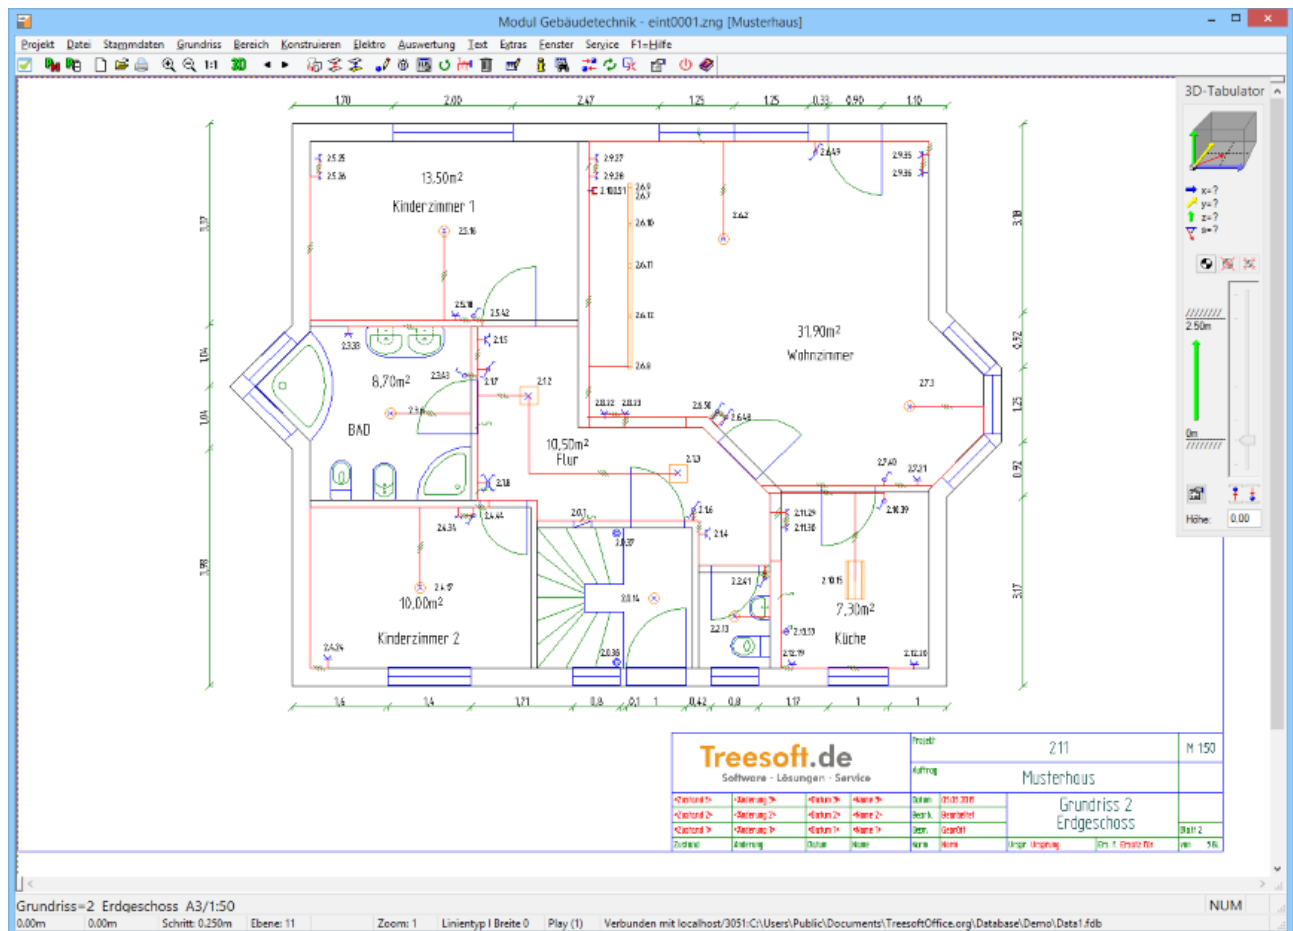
Manuell erstellter Grundrissplan
